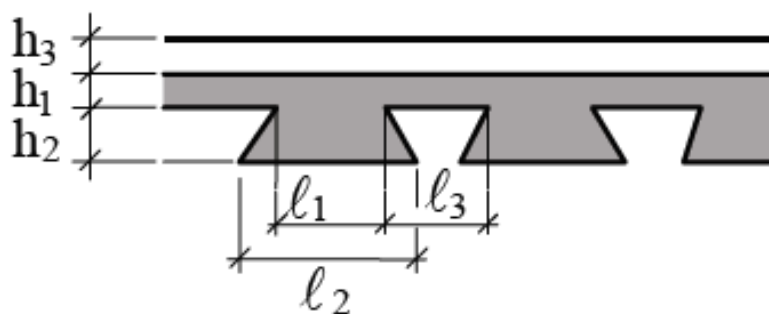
До розрахунку сталезалізобетонної плити перекриття
